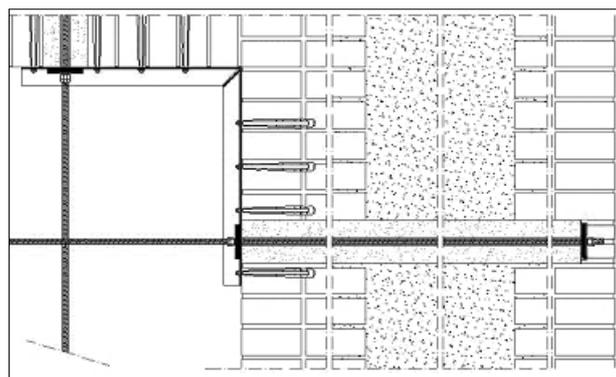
Pavia: castello visconteo. Torre Sud/Est: pianta con particolare della cerchiatura delle murature perimetrali, sfruttando le buche pontai.
